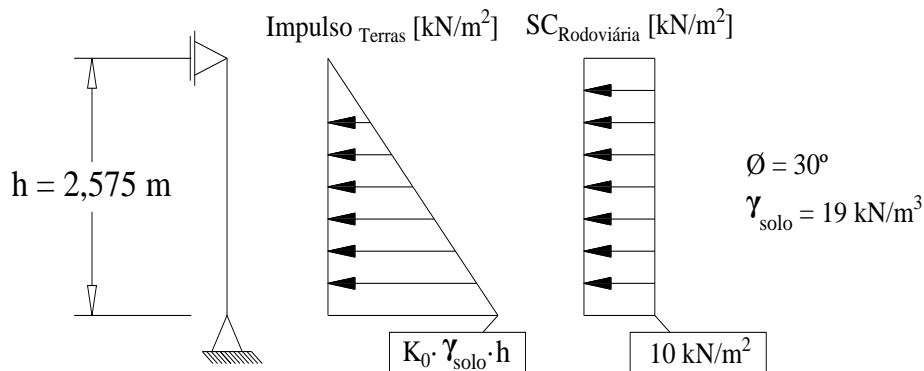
Representação esquemática das cargas aplicadas no muro de suporte.
